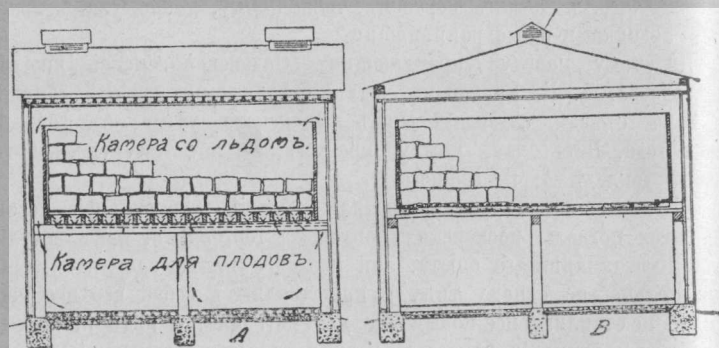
Продольный и поперечный разрѣзы постройки для храненія льда въ верхнемъ этажѣ и плодовъ въ нижнемъ.
